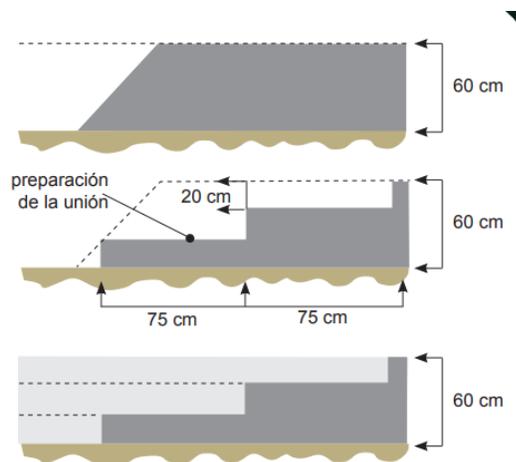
Traslape en la unión de impermeabilización con arcilla.
